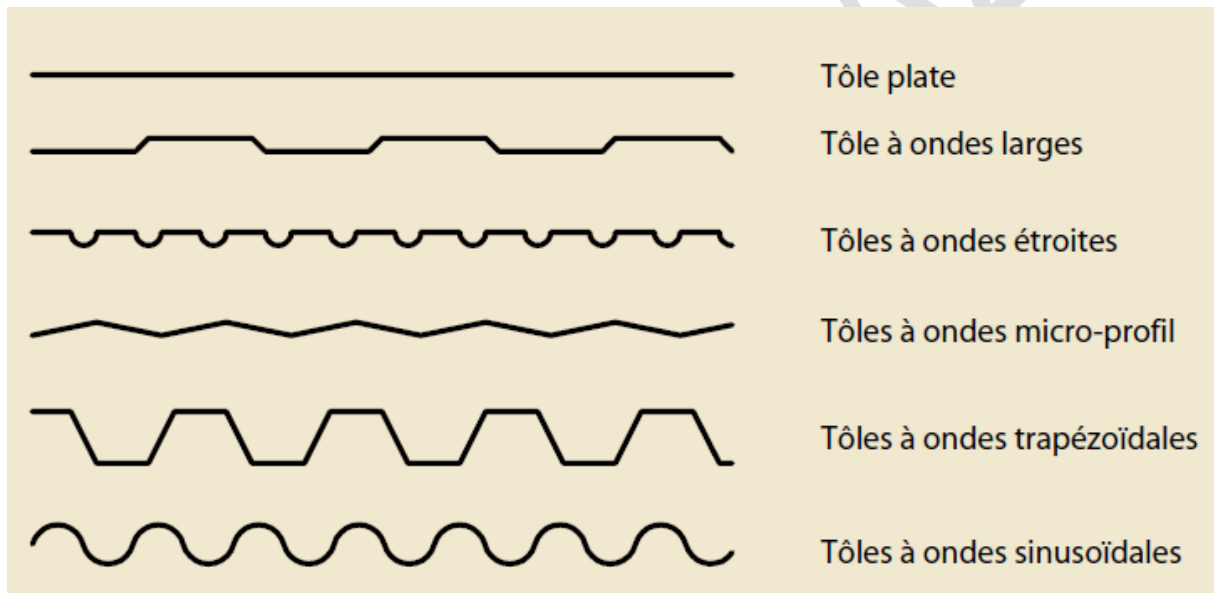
Types de profilage extérieurs pour panneaux-sandwich
